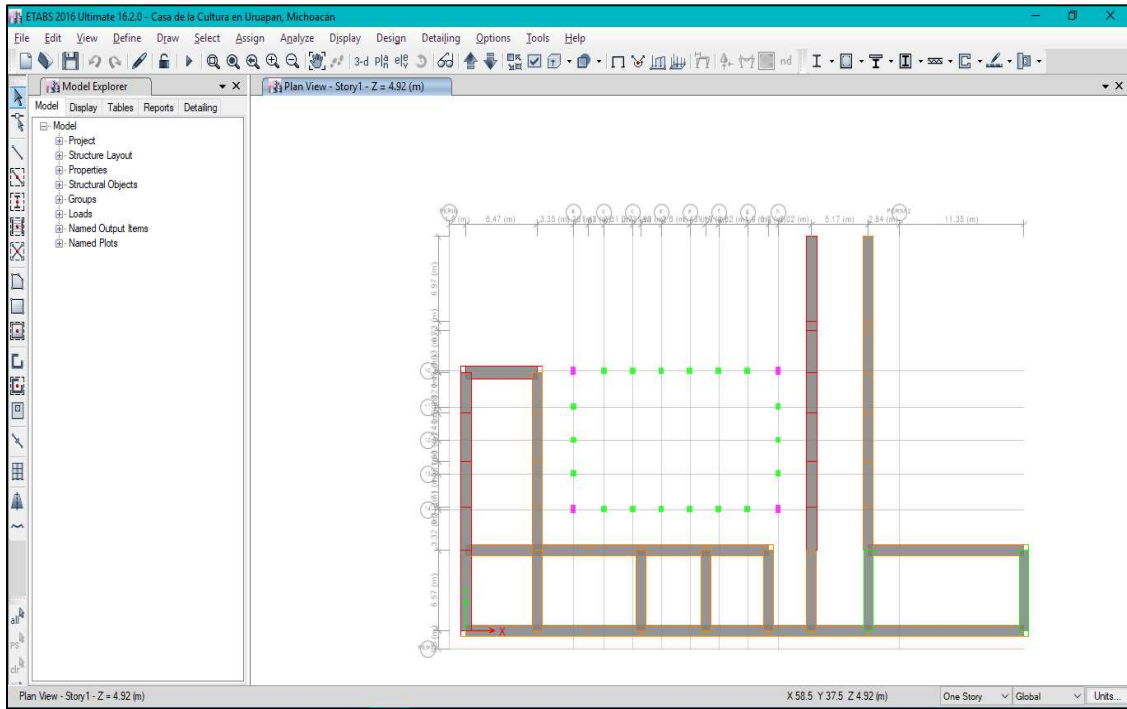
Vista en planta de muros en ETABS 2016. (Fuente: Propia; 2019)
